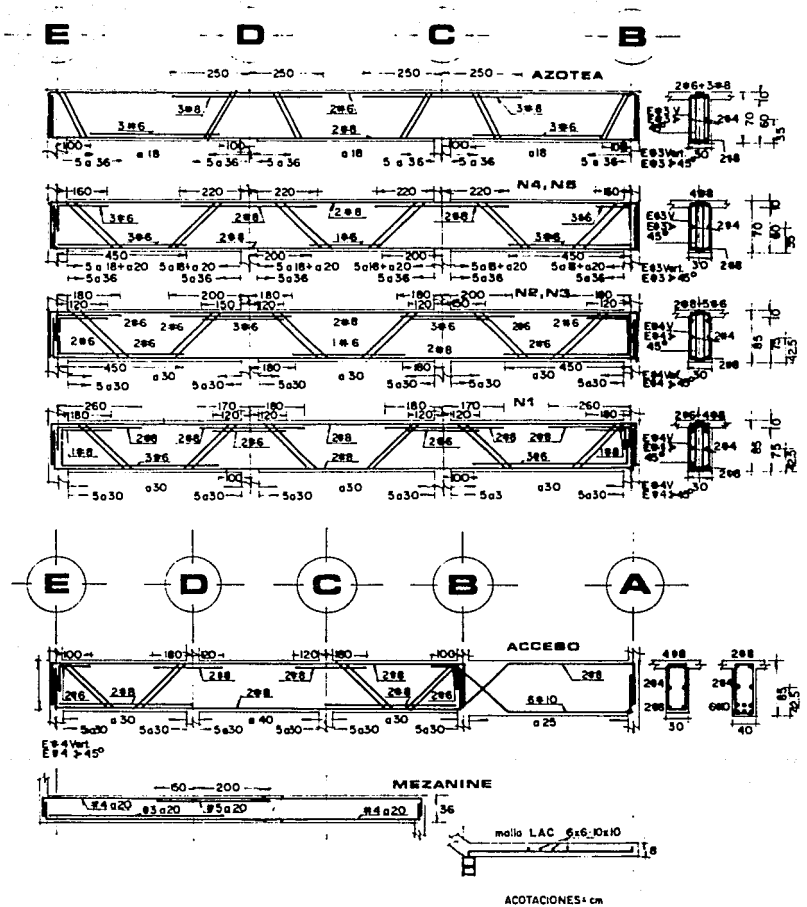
ARMADOS DE VIGAS Y LOSAS DEL EJE 8
